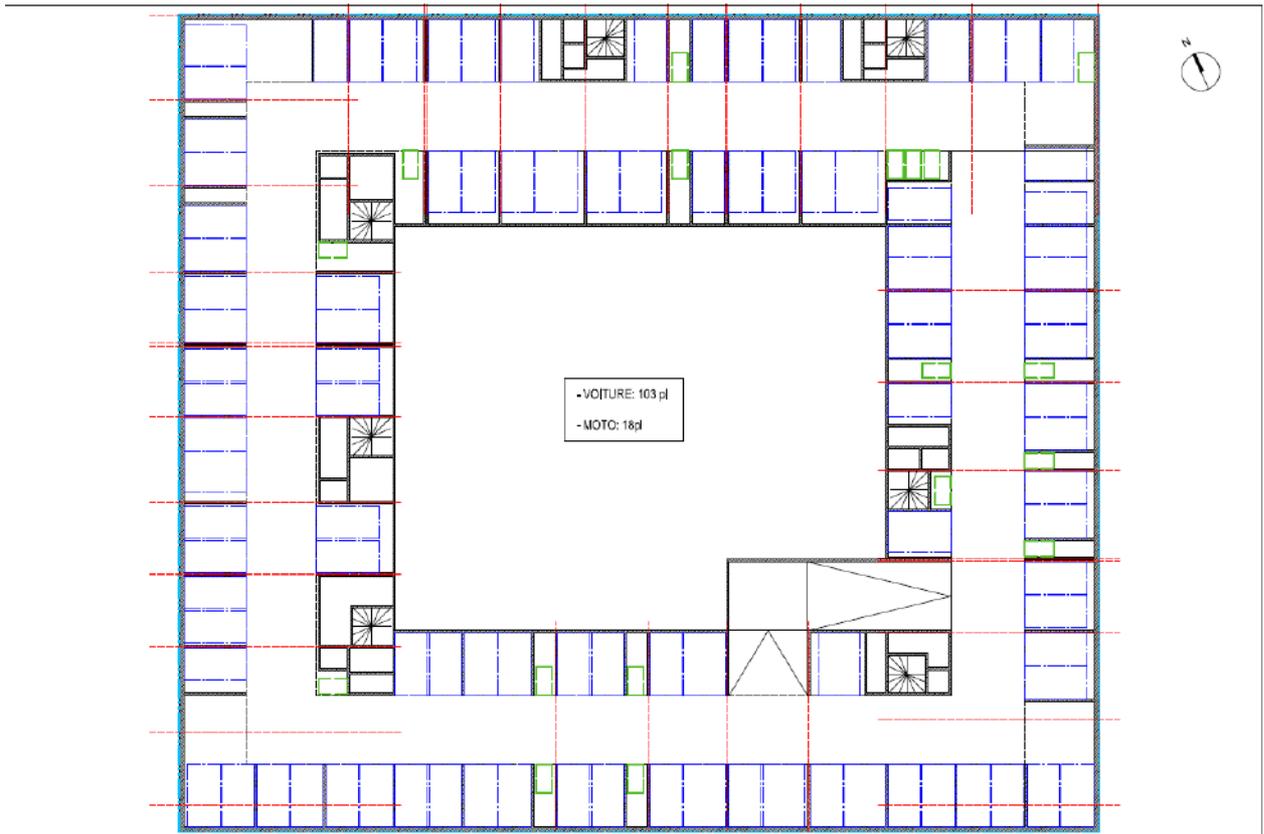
Projet d'aménagement du site -plan masse, R-1 et R-2 (source : SOLEAM)
